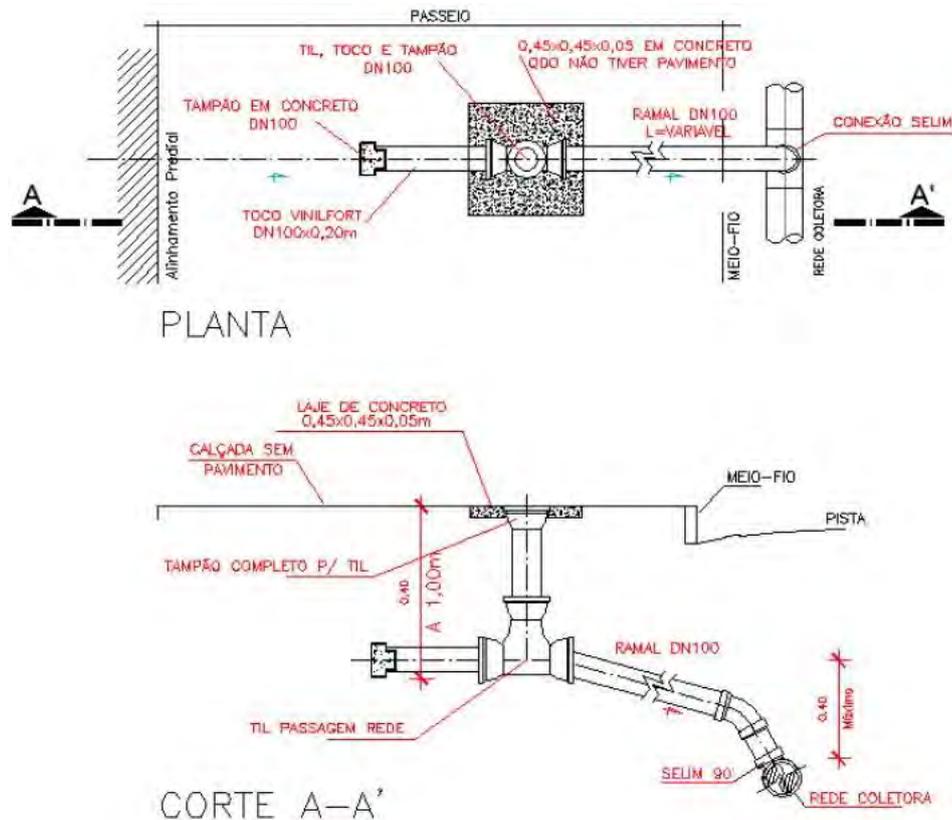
Padrão SANESUL de Ligação Domiciliar de Esgoto – Planta e Corte.
